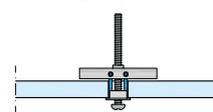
Knauf Hartmut Hohlraumdübel Schraube M5
